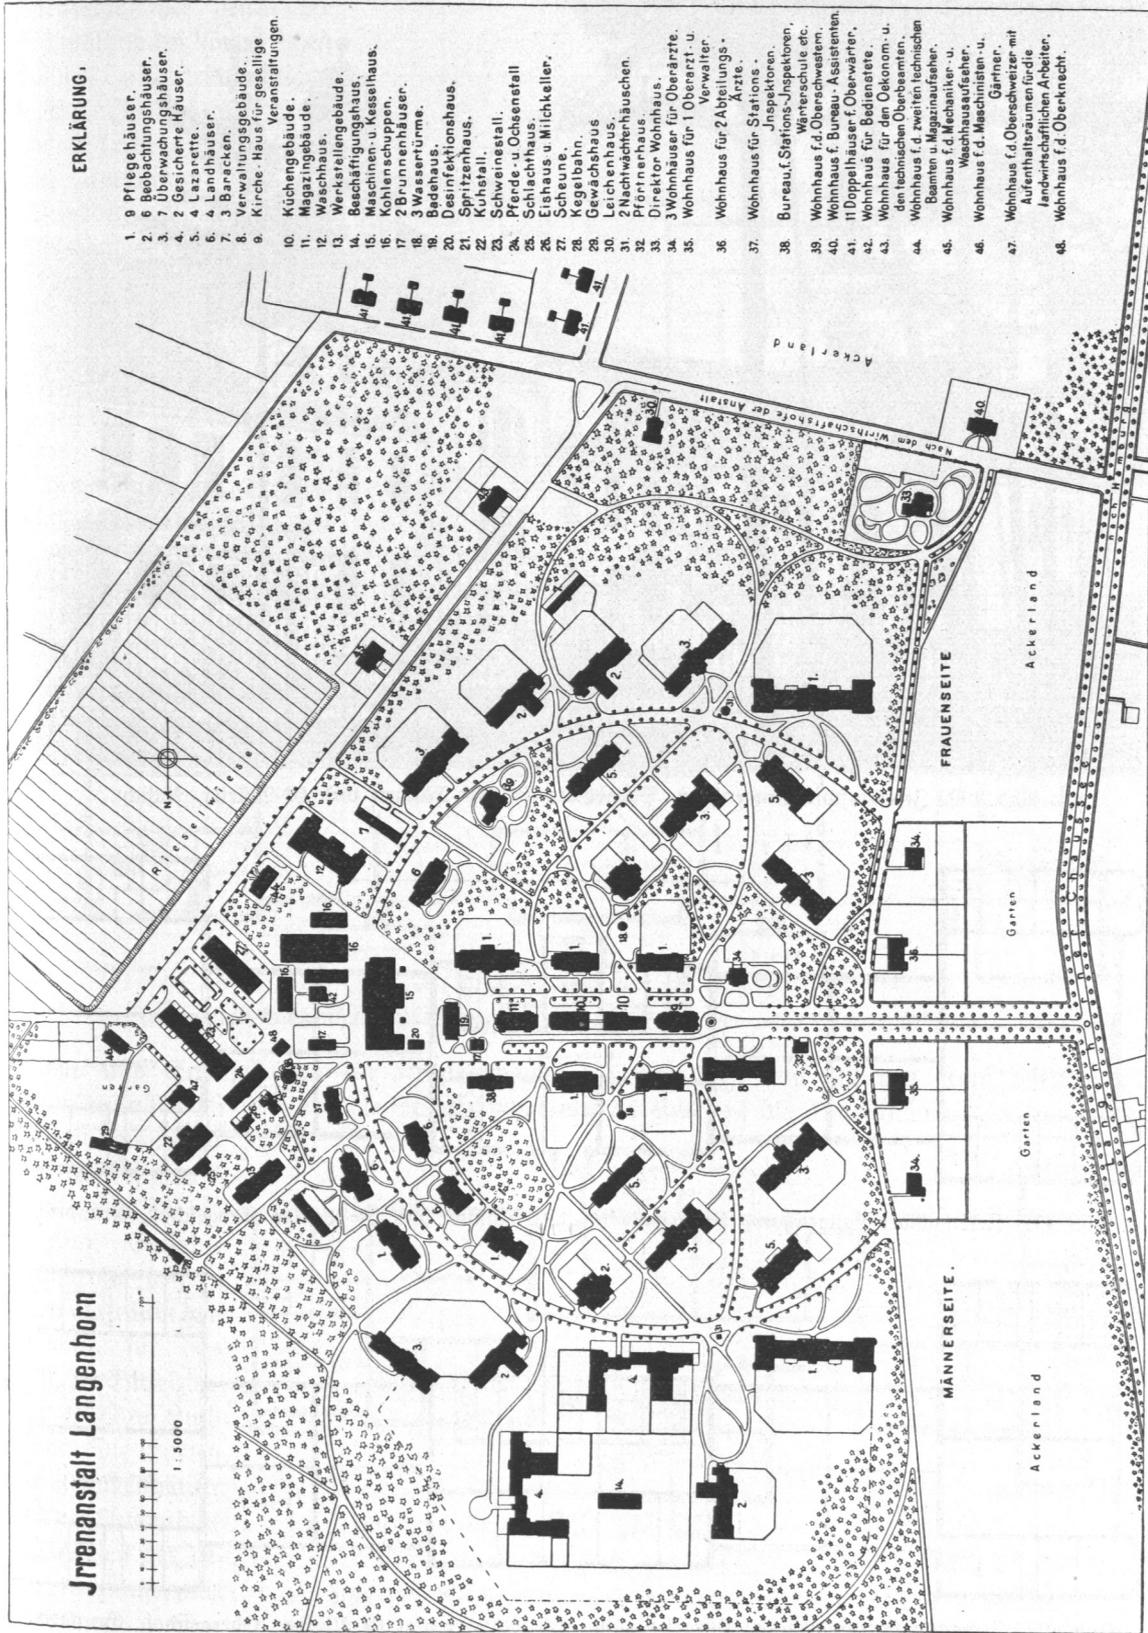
Lageplan der Irrenanstalt Langenhorn.
